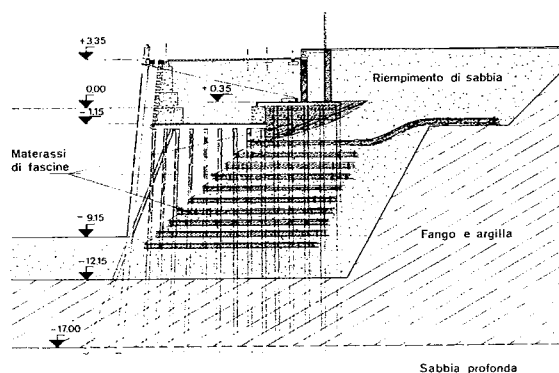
PORTO DI ROTTERDAM. Banchina tradizionale - 1901.
